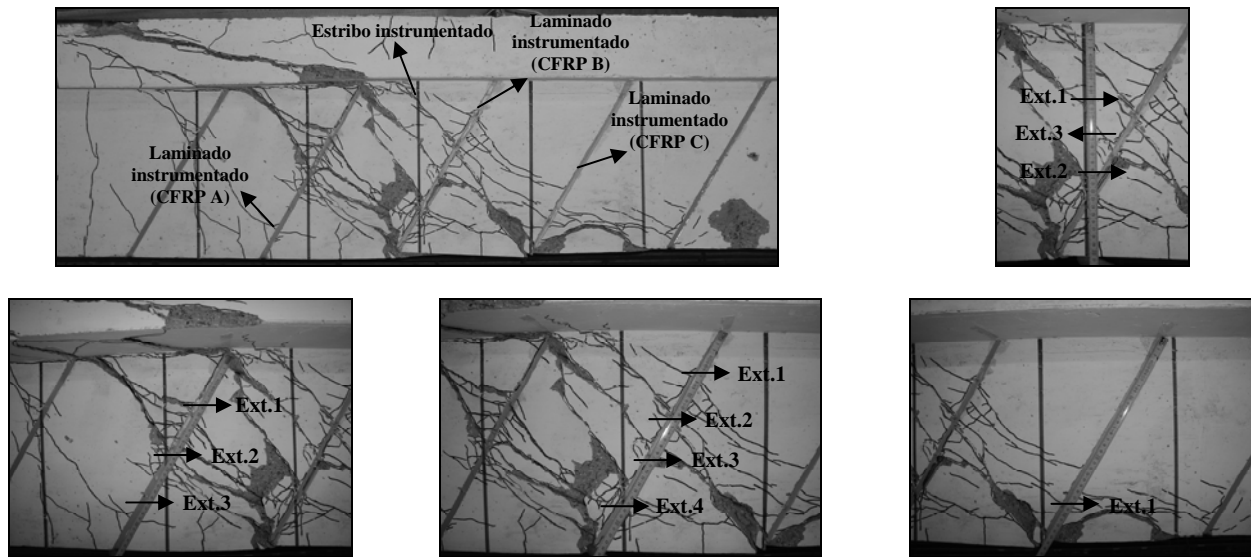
Localização dos extensômetros no laminado e estribo instrumentados da viga 5S-5LI60F-D.
